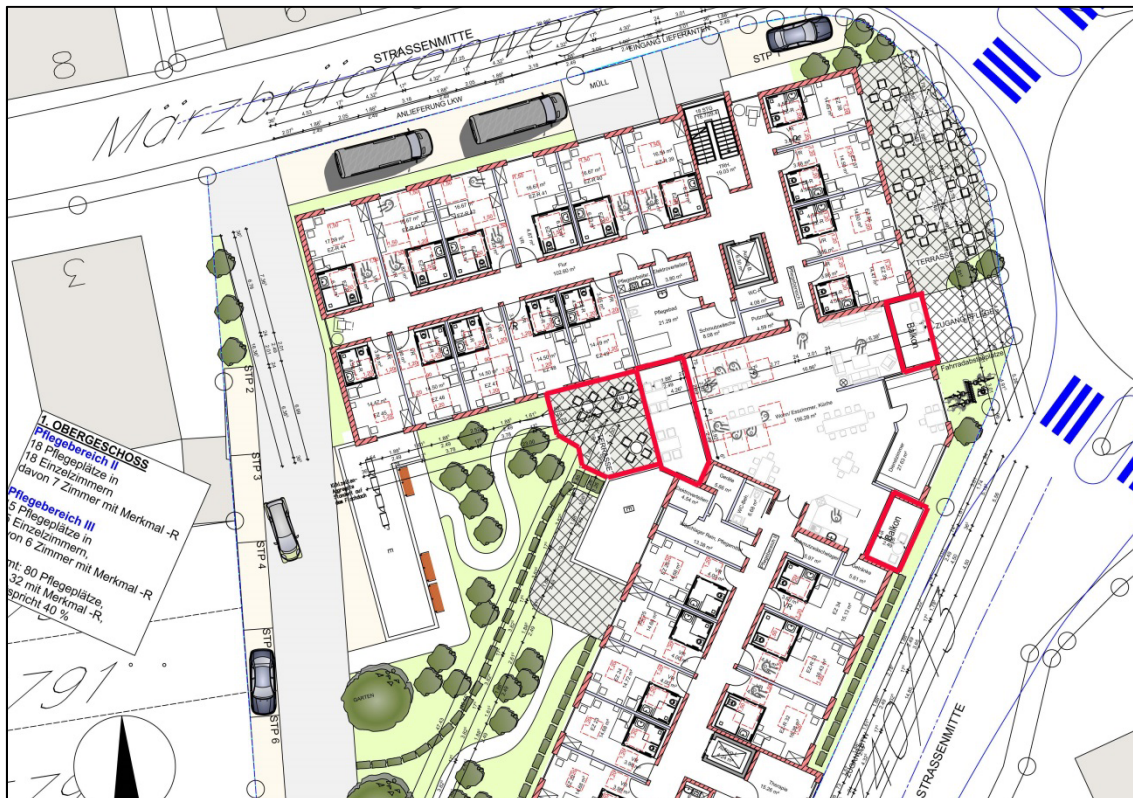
Grundriss OG1 mit Kennzeichnung der schutzbedürftigen Außenwohnbereiche
